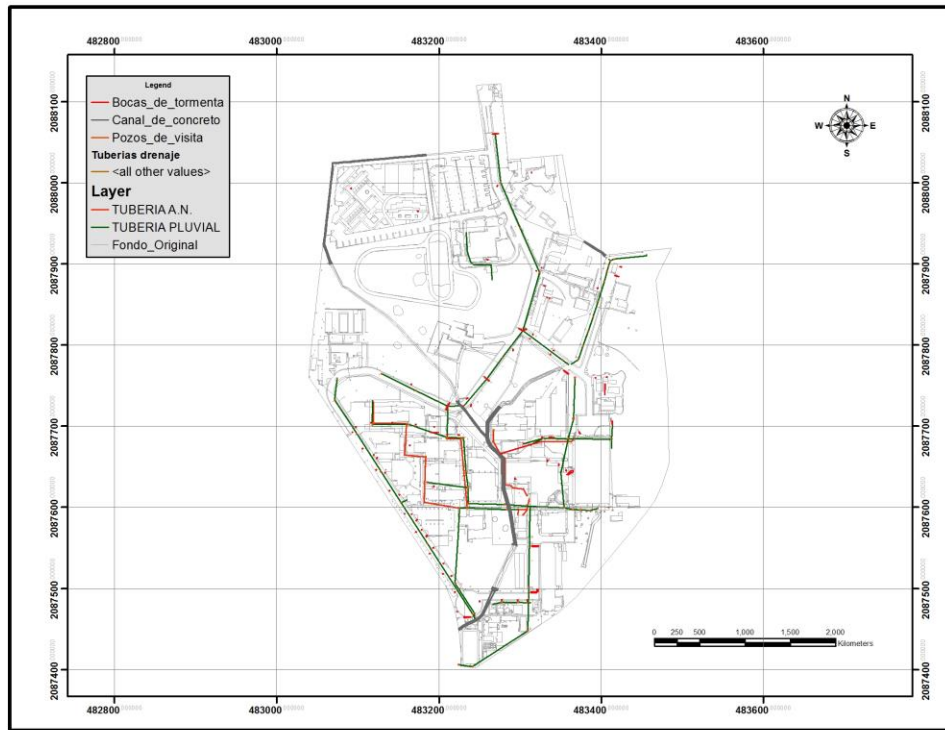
SHP de la Red de drenaje Pluvial y alcantarillado sanitario
